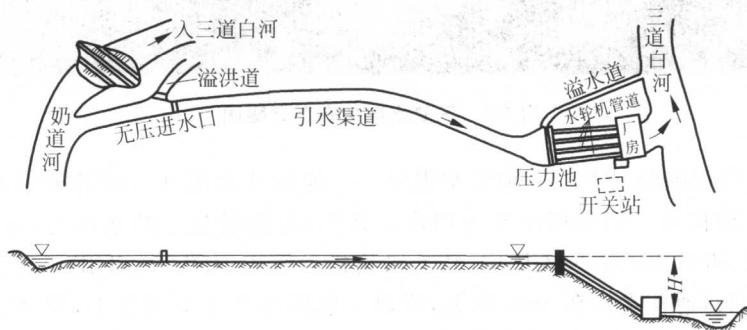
某明渠引水式水电站的平面布置和纵剖面图
